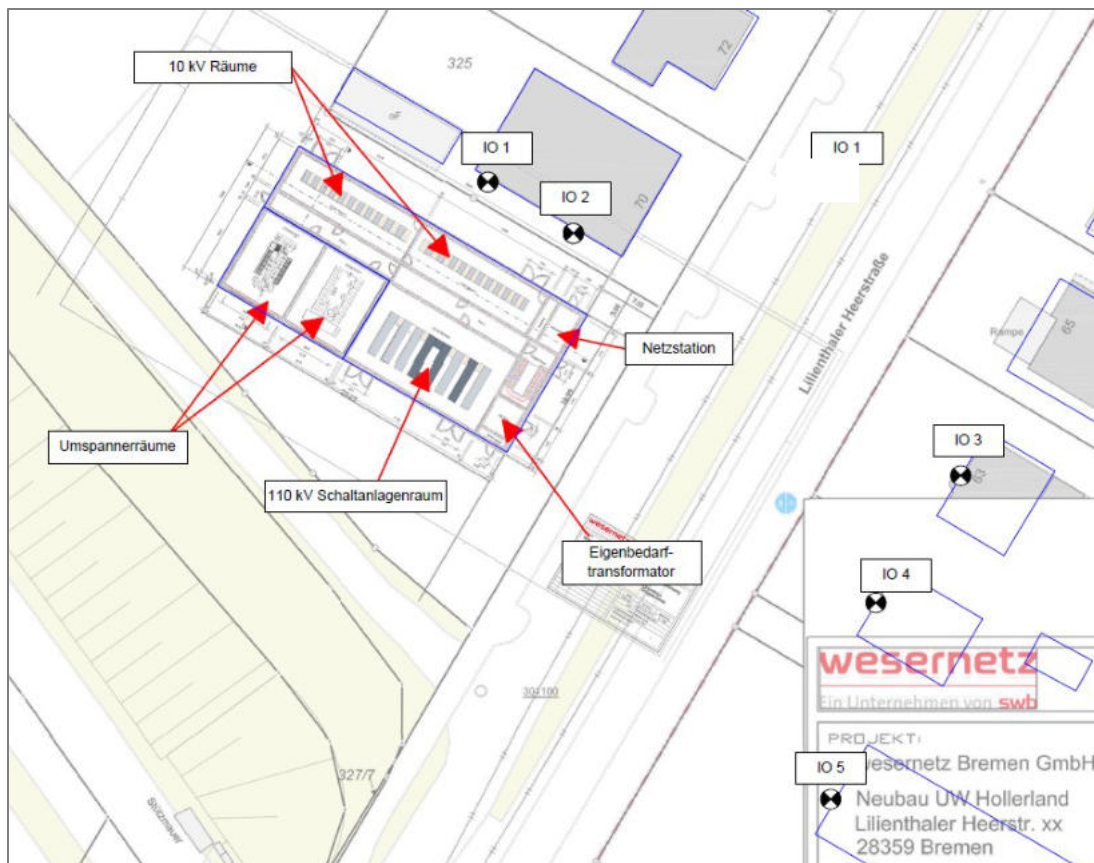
Lageplan mit Grundriss und Immissionsorten, Quelle: TÜV Nord
